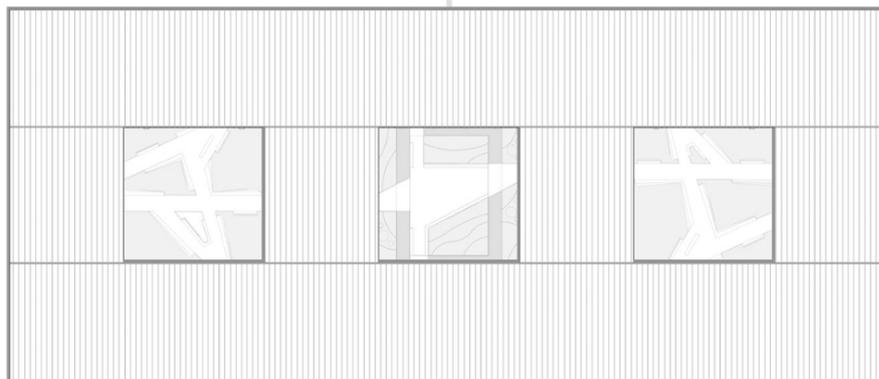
Moradias Infantis – Planta Baixa do Pavimento Superior.
